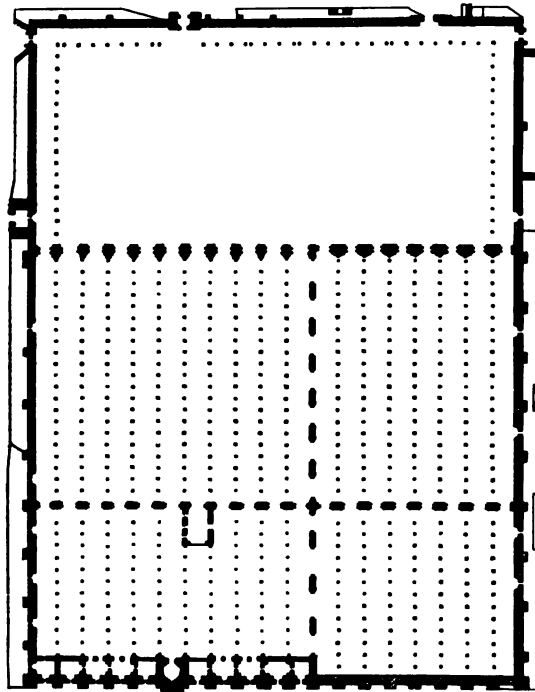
Grundriss der Moschee zu Cordova
